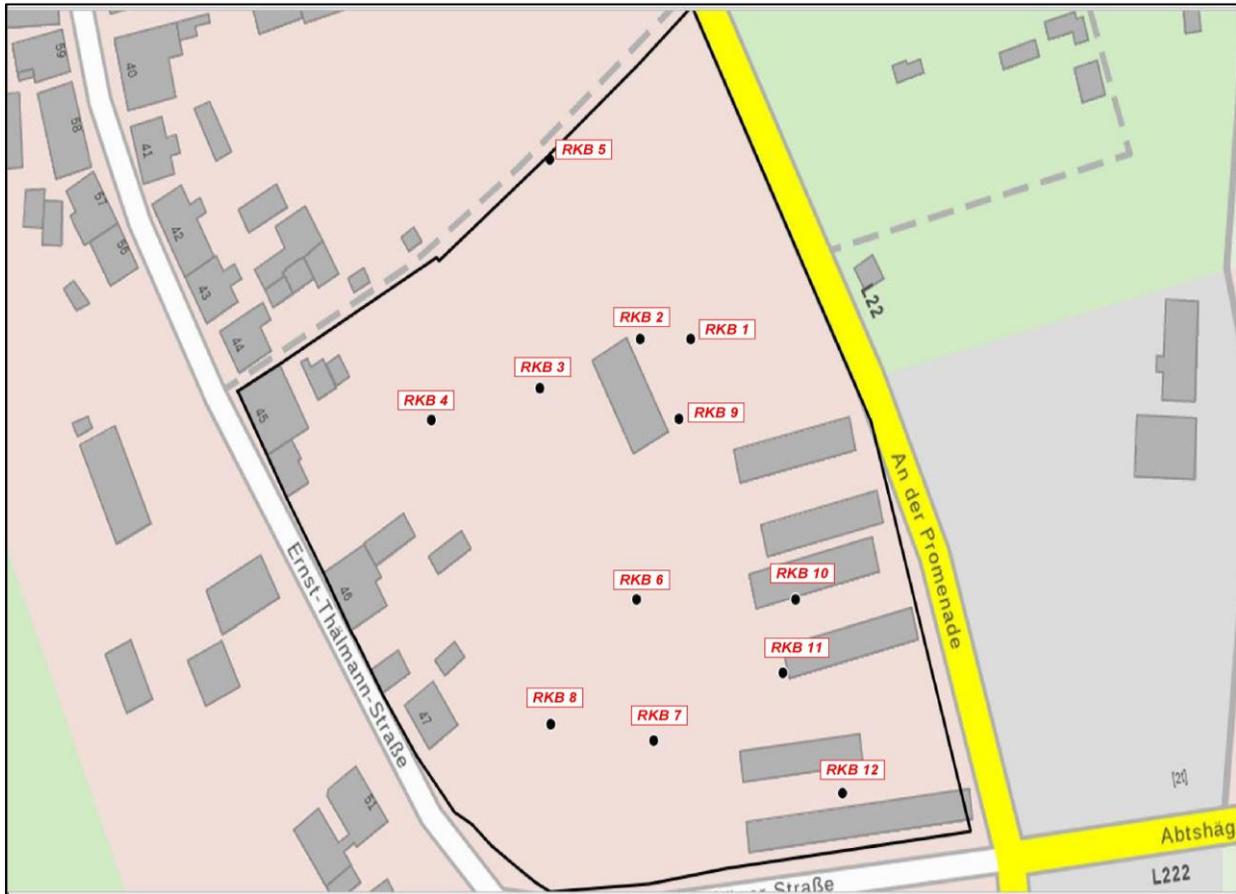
Lageplan Geltungsbereich B7 Stadt Franzburg und Punkte der Bodenproben - Aus: Erdbaulabor Hinrichs Geotechnischer Bericht 92-2022 (11.07.2022)
